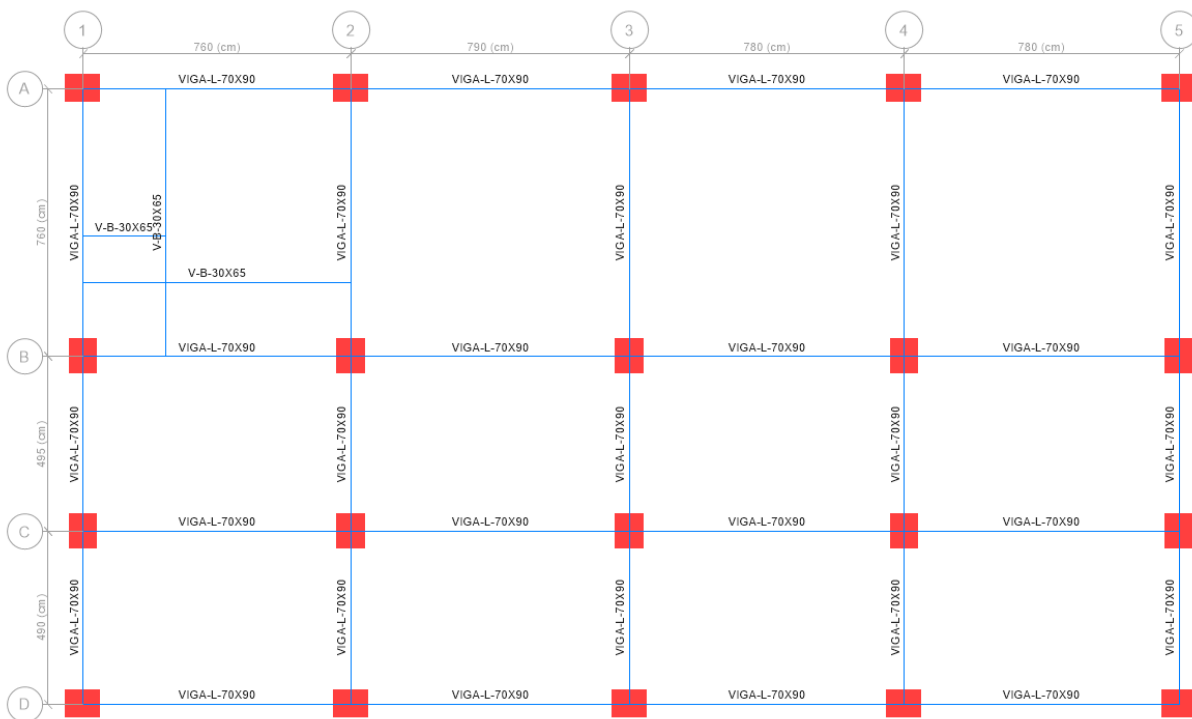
Vista en planta de vigas para el caso de estudio 1 - Etabs
